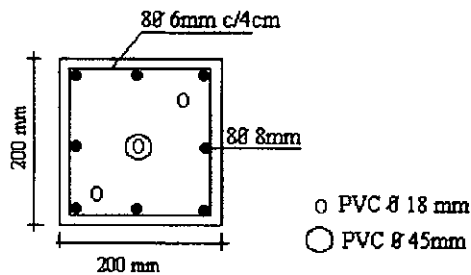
Detalhamento dos prismas de concreto armado.
